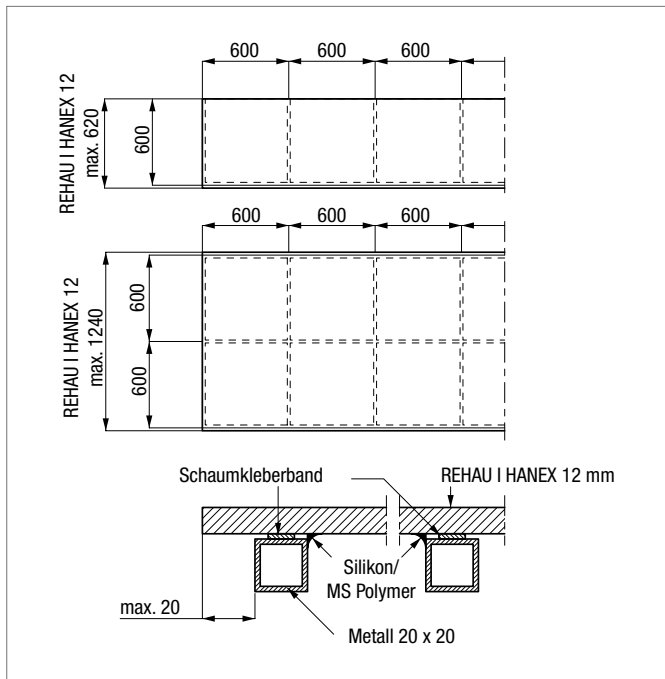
Flächige Fixierung REHAU I HANEX 12 mm
